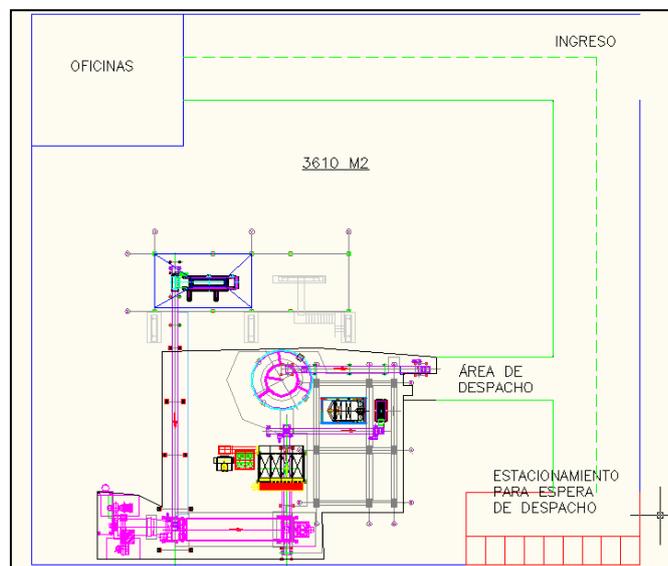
VISTA SUPERIOR DE PLANTA DE SECADO Y MOLIENDA DE PUZOLANA.
